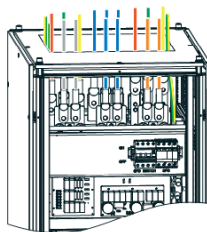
Схема верхнего подвода кабеля для типа МРМ-200-3, МРМ-300-3
